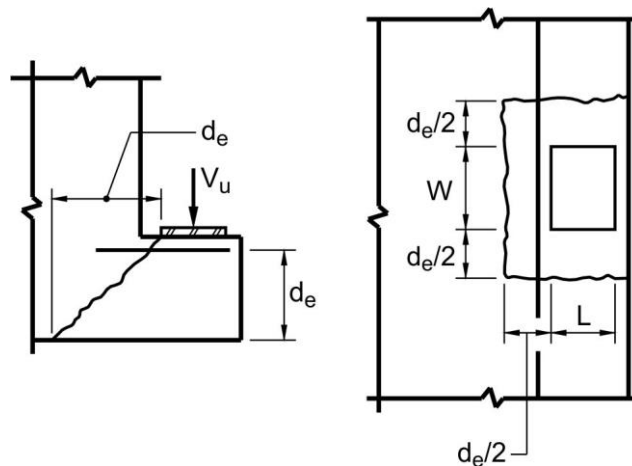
Diseño al punzonado de los resaltos horizontales
